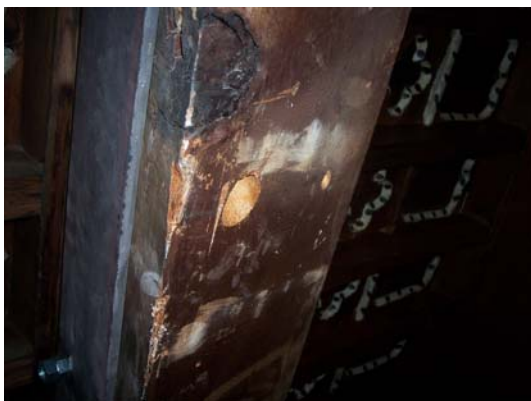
Detalle de una de las perforaciones realizadas con la broca gorda donde posteriormente se introducirán las piezas de madera que deben conecta la madera original con la madera nueva.
